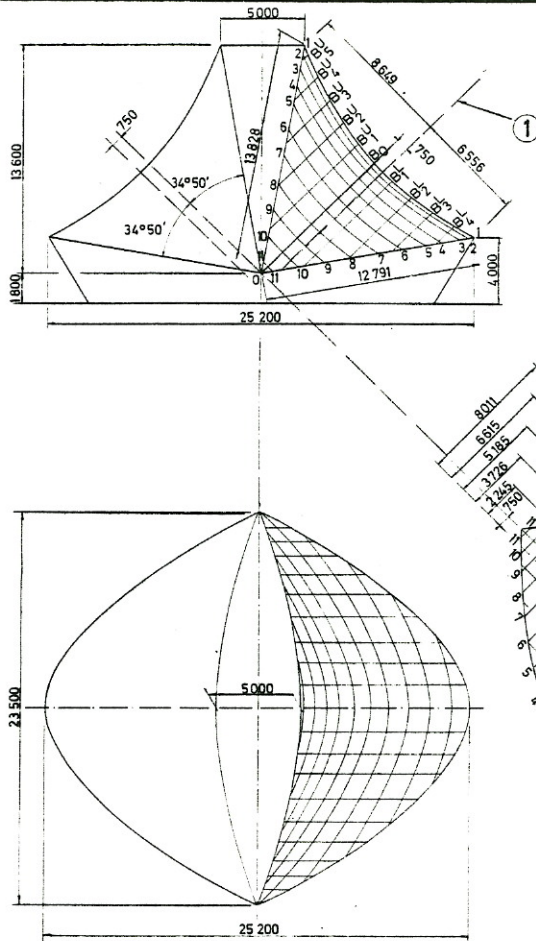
Disposizione delle funi al montaggio. Prospetto laterale, vista dal disopra e vista secondo l'asse del paraboloide. (1) Questo asse è scalato di 750 mm rispetto al piano mediano dei due piani inclinati che delimitano il paraboloide (il piano dell'arco e quello della faccia superiore del basamento in c.a.).
